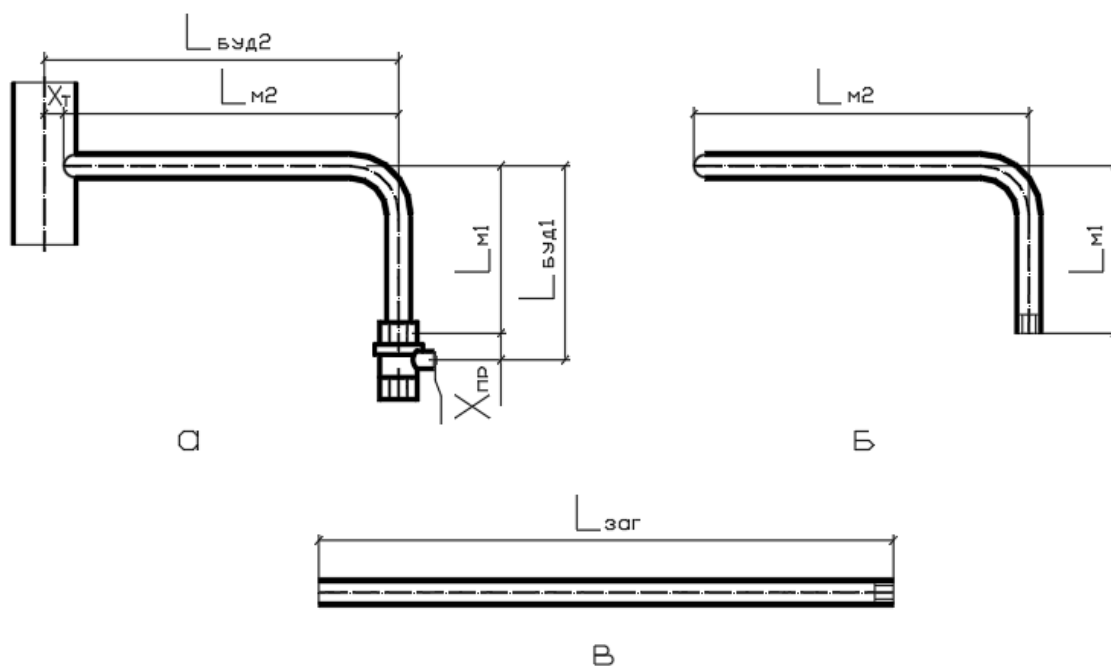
Трубний вузол (а), деталь (б) і труба заготовка (в):
